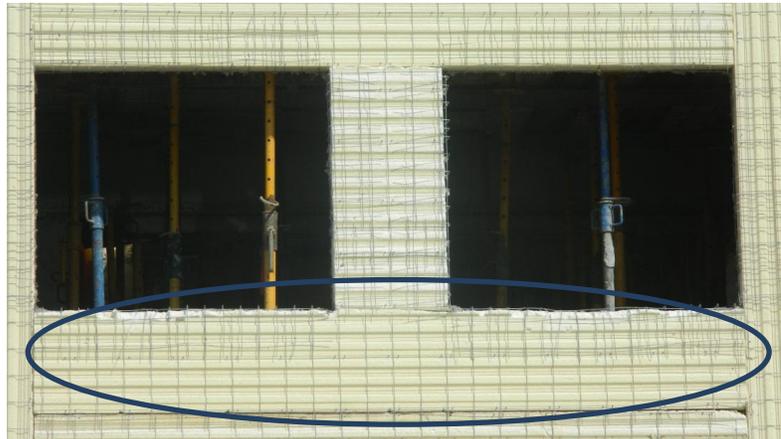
Vista en detalle de los paneles horizontales encima y debajo de la las ventanas
